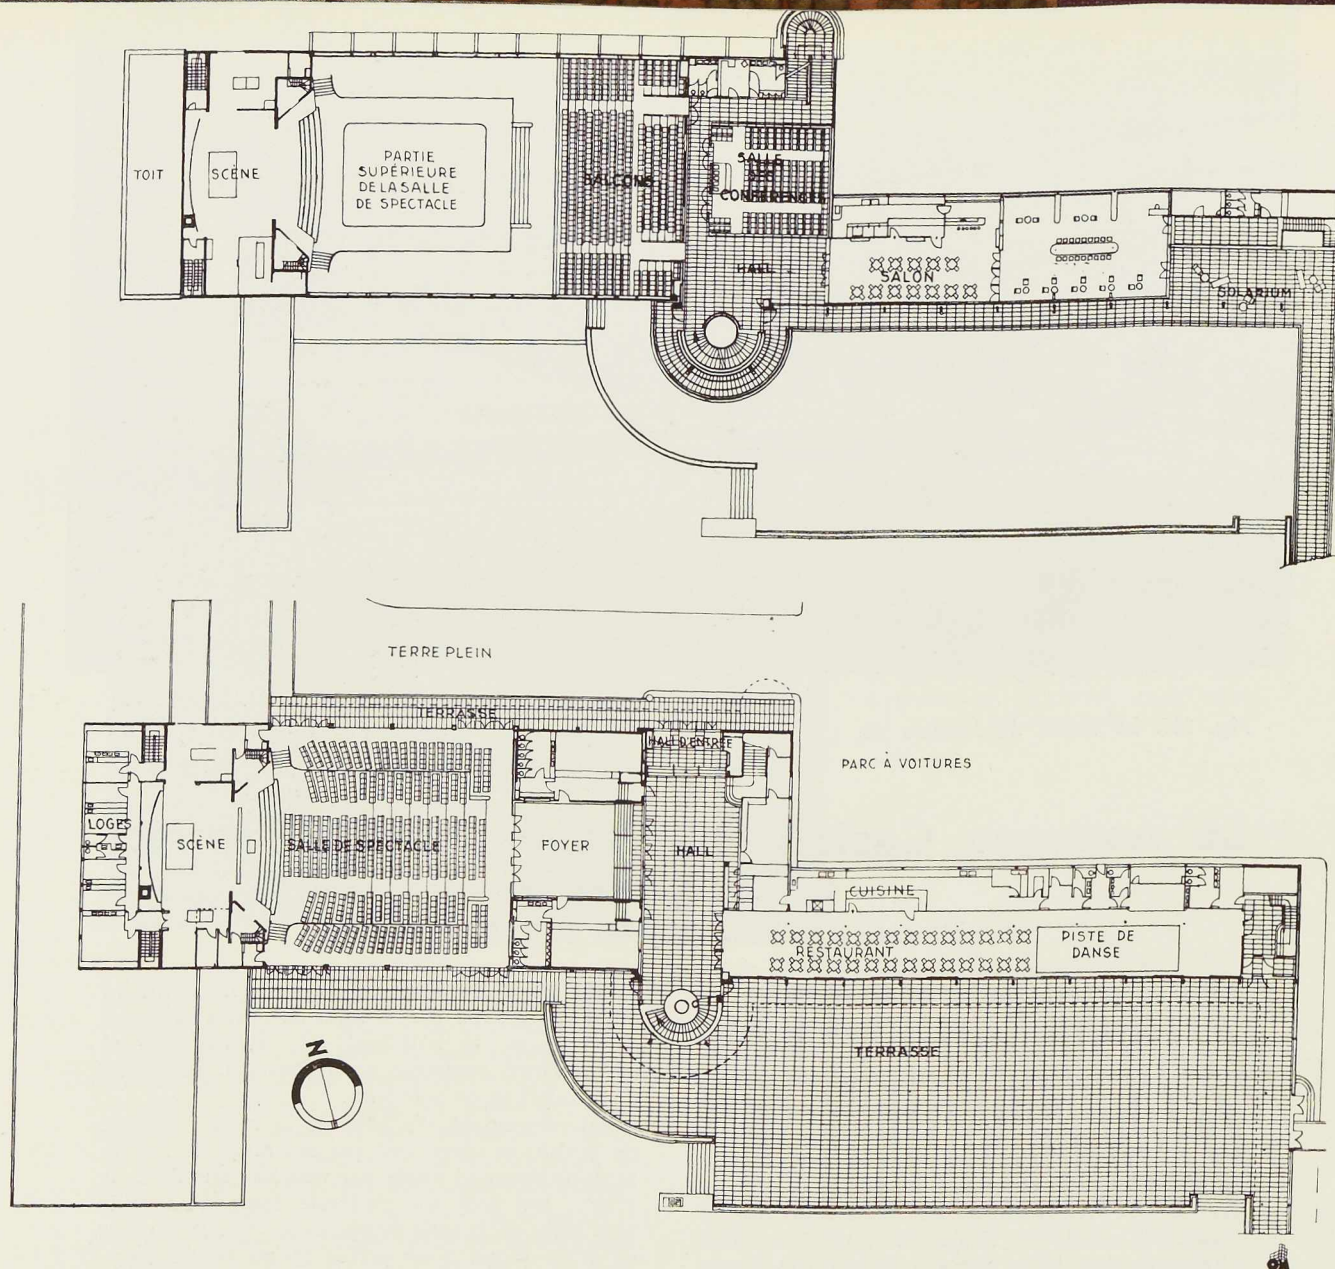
et 168. Plan du rez-de-chaussée et du premier étage.
